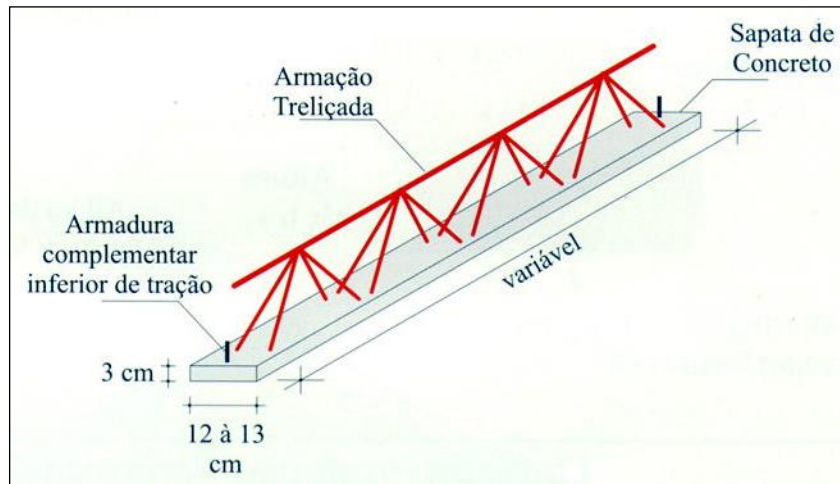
Nervura da laje treliçada (FAULIM, 1998).
